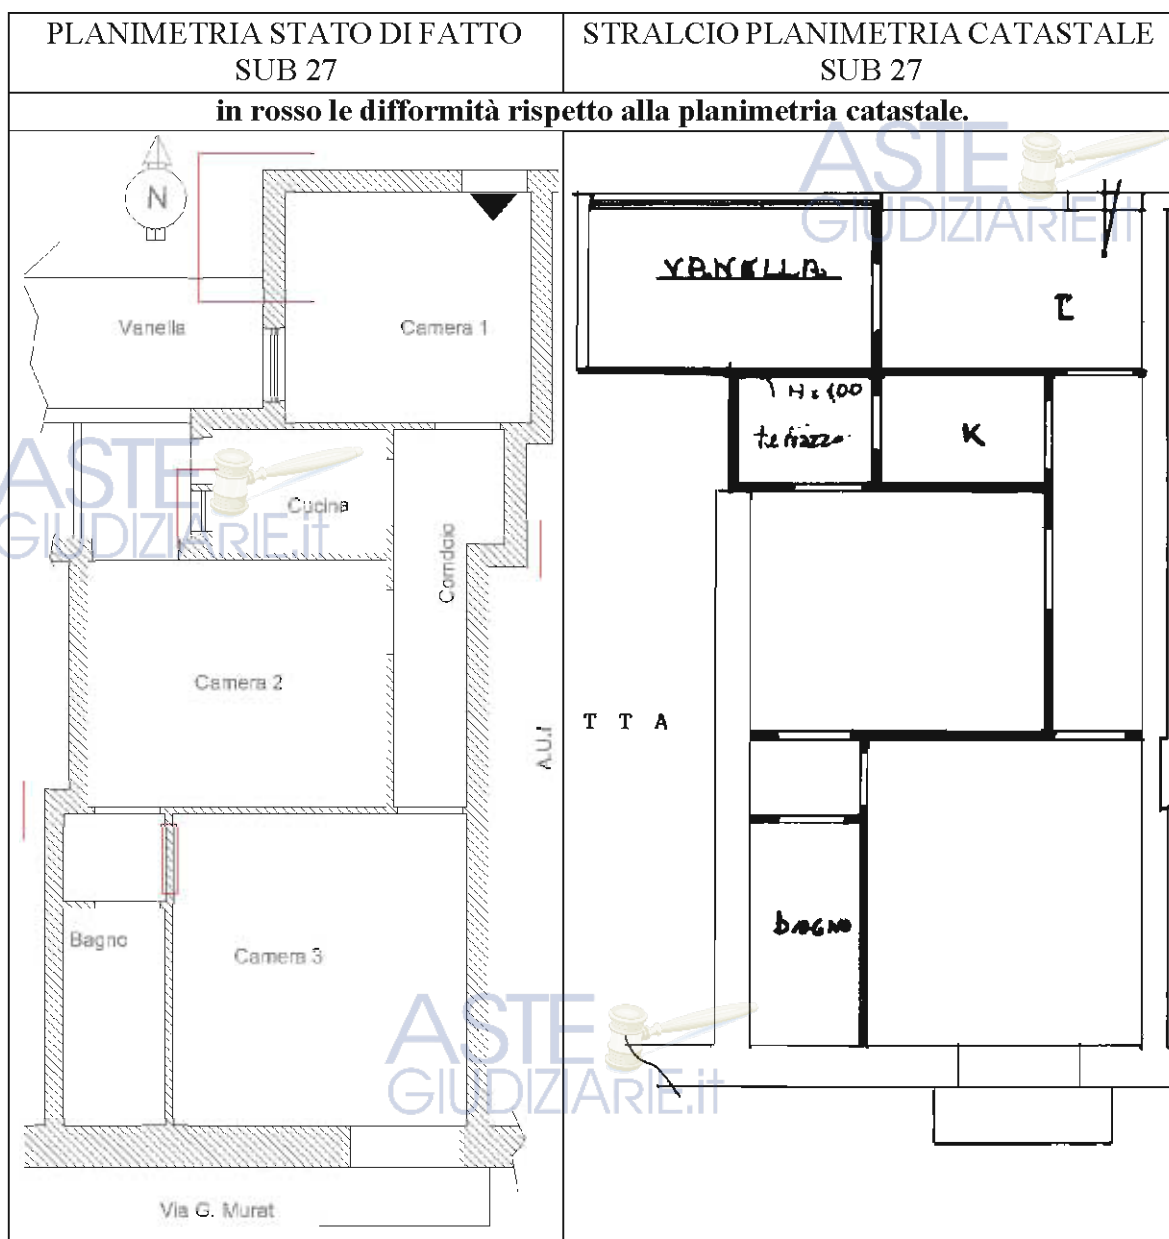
Stato di fatto e Stralcio Planimetria SUB N.27.
